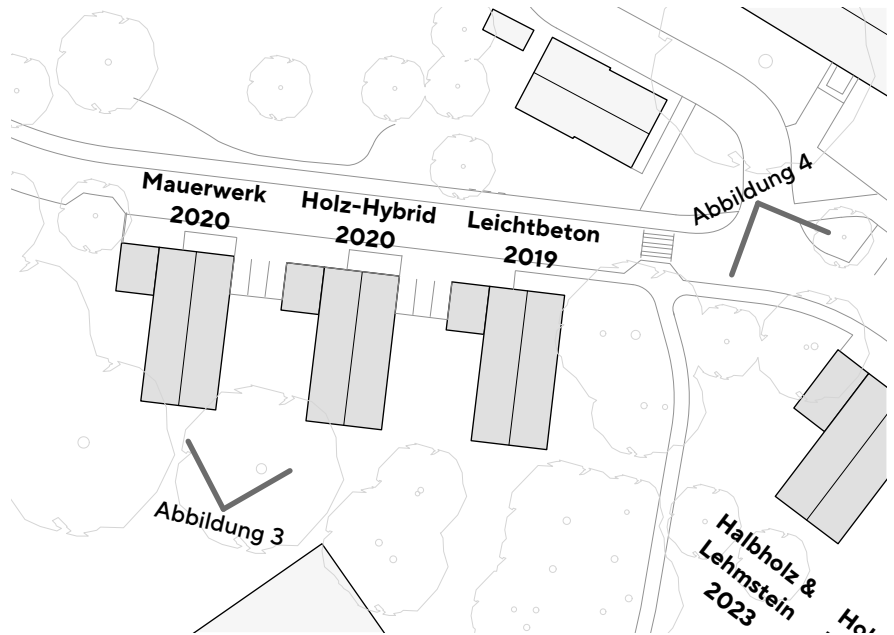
Lageplan der Forschungshäuser mit Angaben zu Material und Baujahr
